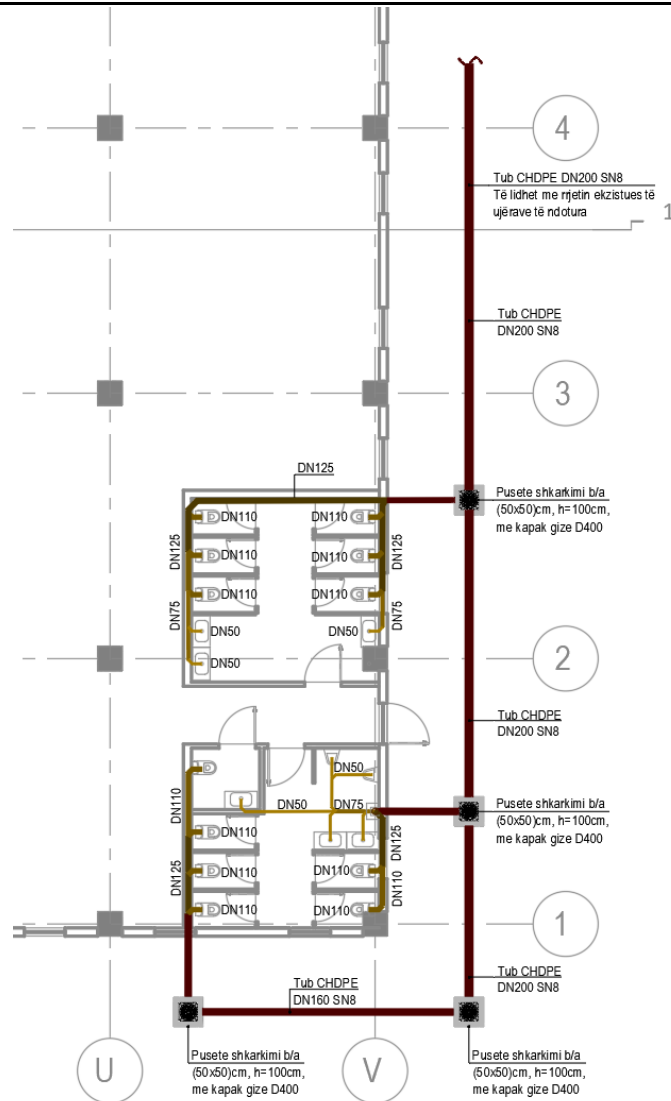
Planimetria e Shkarkimit të Ujerave të Ndotura të Nyjes Sanitare në magazinë
